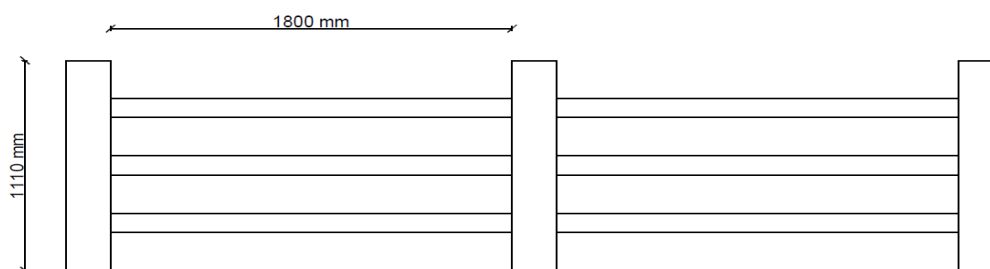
Vista longitudinal de las protecciones laterales del puente. Elaborado por: El autor.
